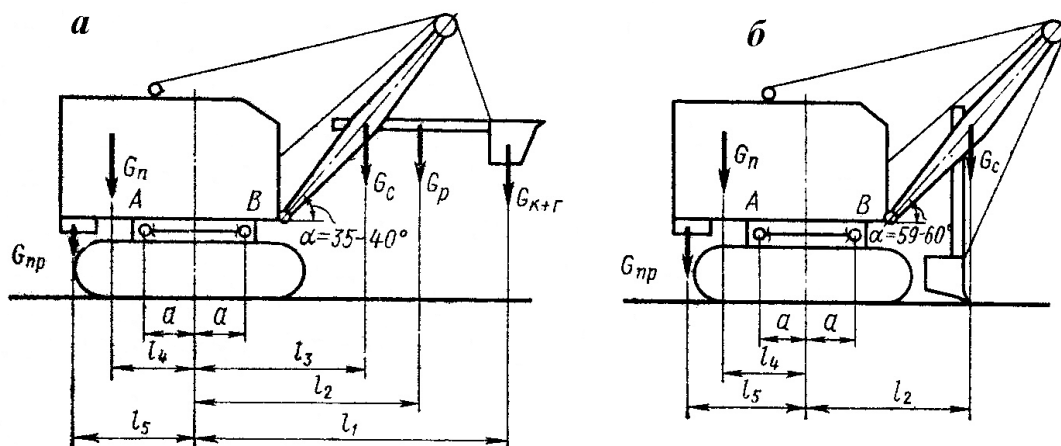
Схема к определению веса противовеса при рабочем оборудовании прямой лопата:
